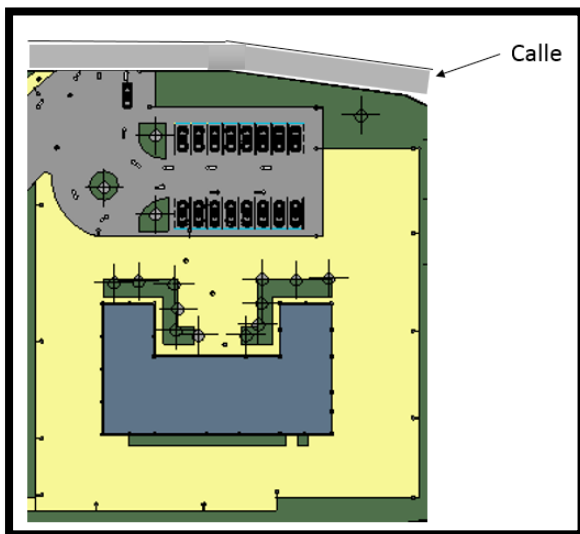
Vista en planta del edificio y ubicación respecto a la calle
